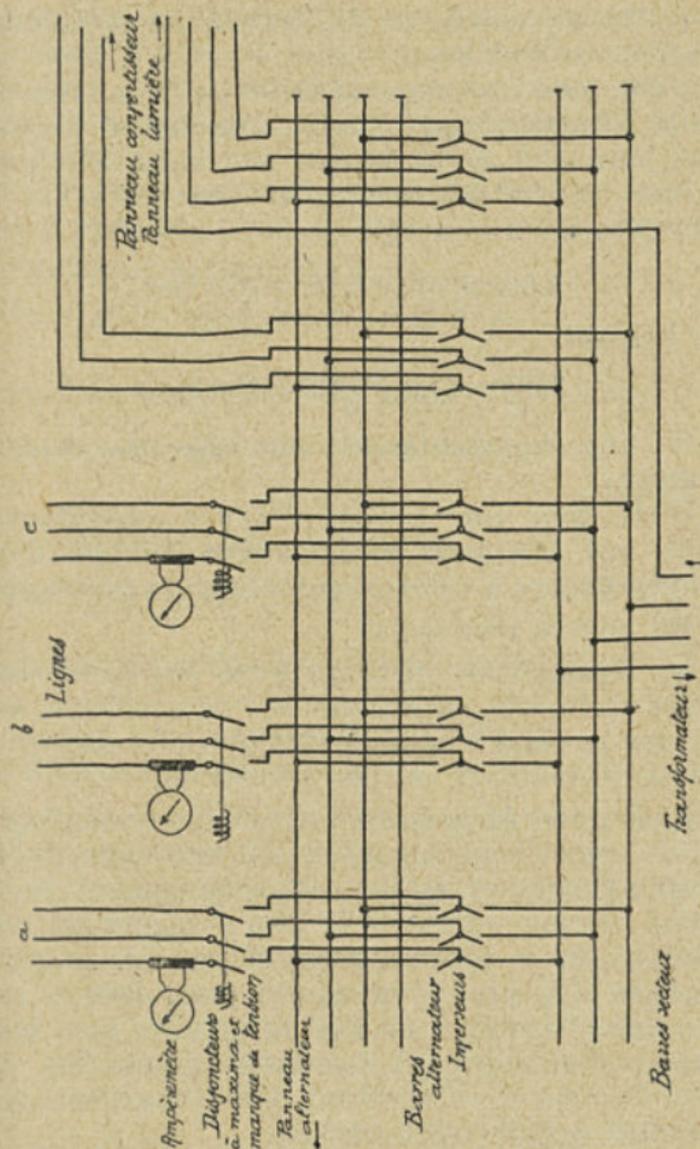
Panneaux des inverseurs permettant d'alimenter l'installation, soit sur secteur, soit sur l'alternateur de secours.
